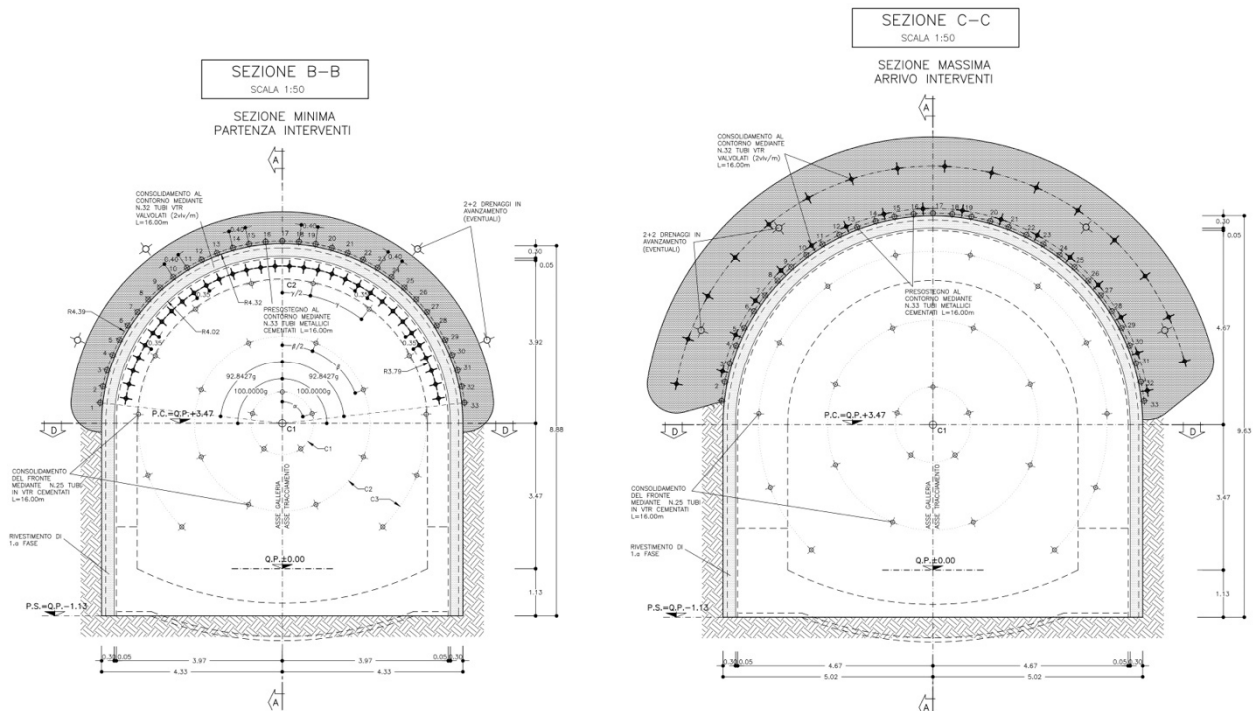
Sezione Tipo C2V – Scavi e consolidamenti - Sezione
